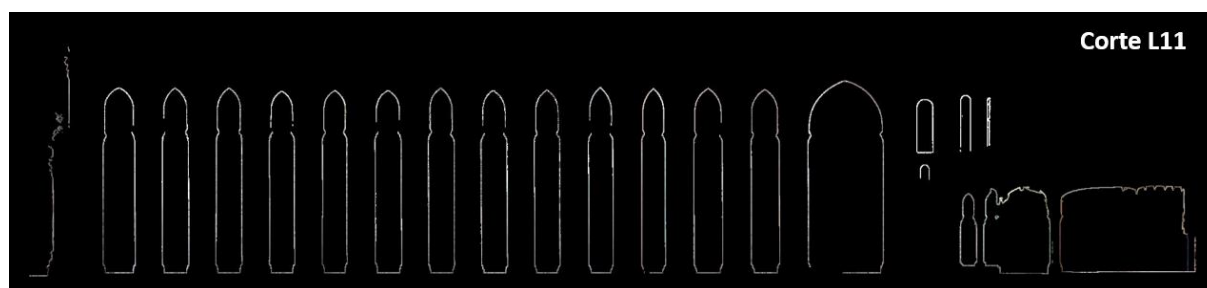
Corte longitudinal que intersecta o centro dos pilares que separam as Naves Central e Sul da Igreja (L11) do Mosteiro de Alcobaça.
